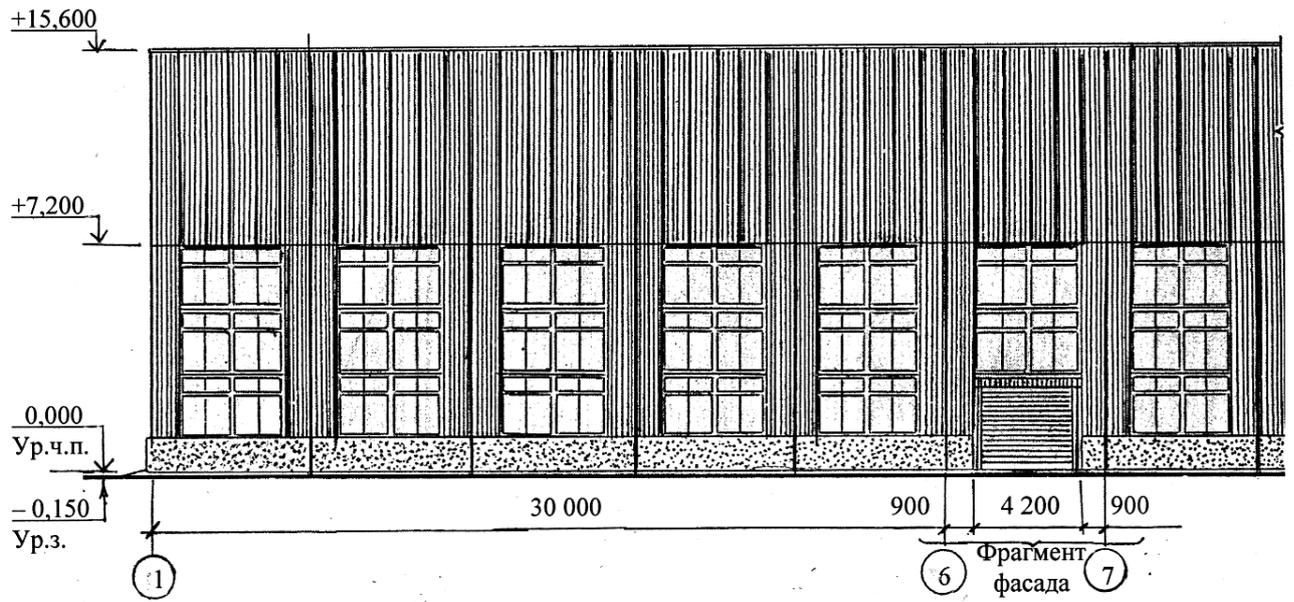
Примеры выполнения фасадов одноэтажных производственных зданий
